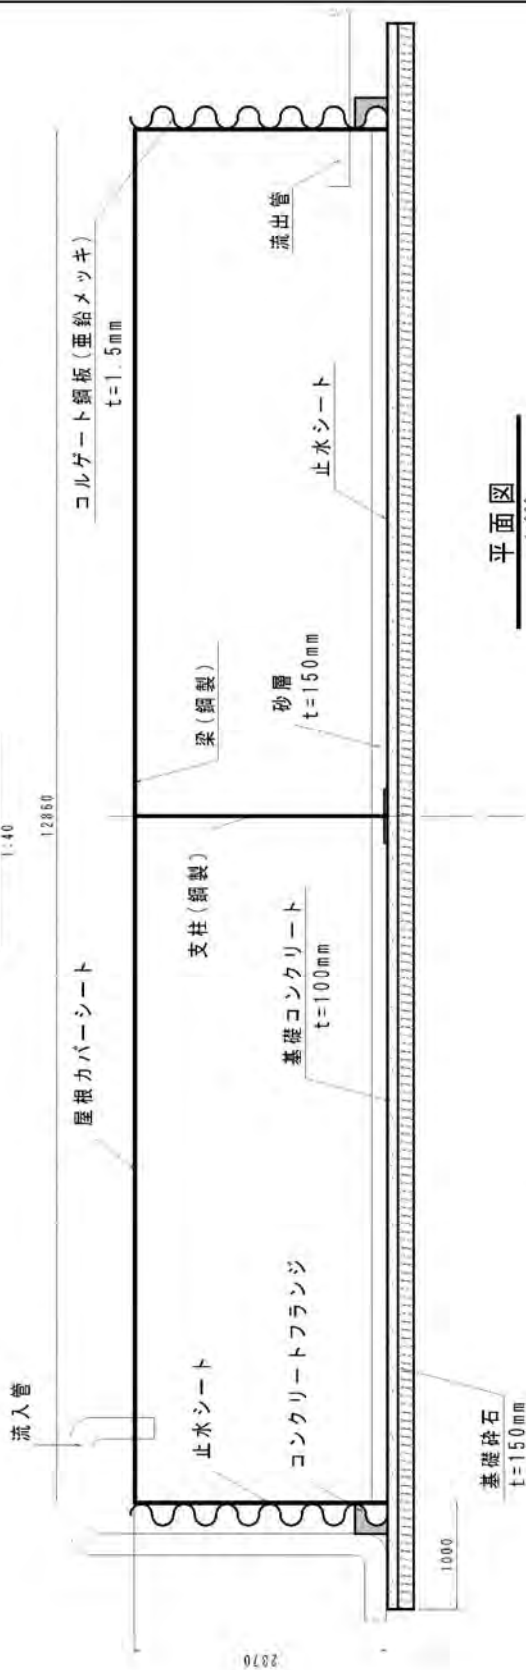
ケース G Frush Beit Dajan 1 計画平面図
